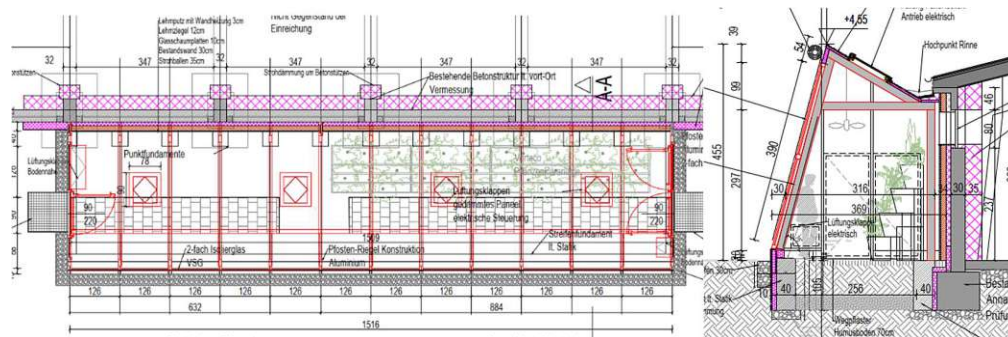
Grundriss und Schnitt Glashaus [46]
